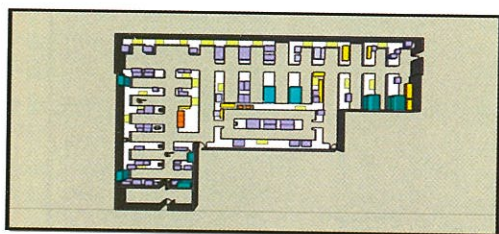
Plano de Piso del Laboratorio 1 (Vista 1)
